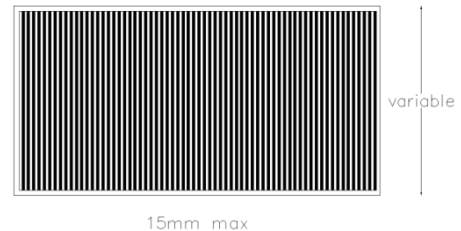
, 218 y 219: Detalle de coladera/rejilla. Elaborada por la autora.
